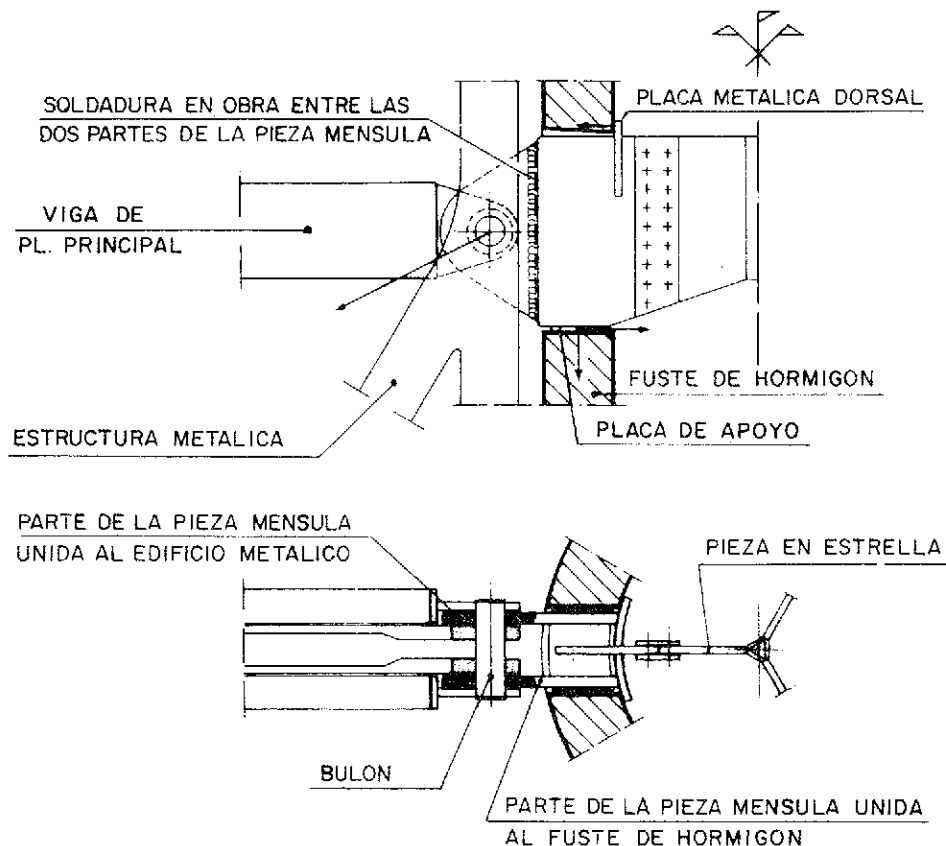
Disposición de las piezas ménsula y en estrella, de una planta principal.
